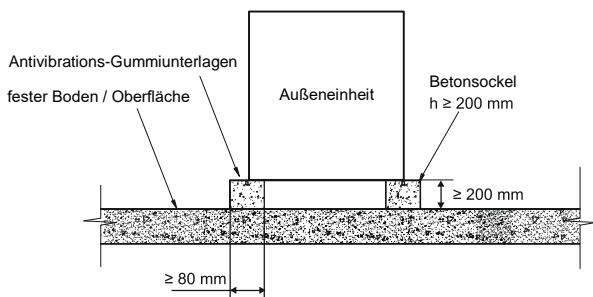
Konstruktion des Sockels – Frontansicht
